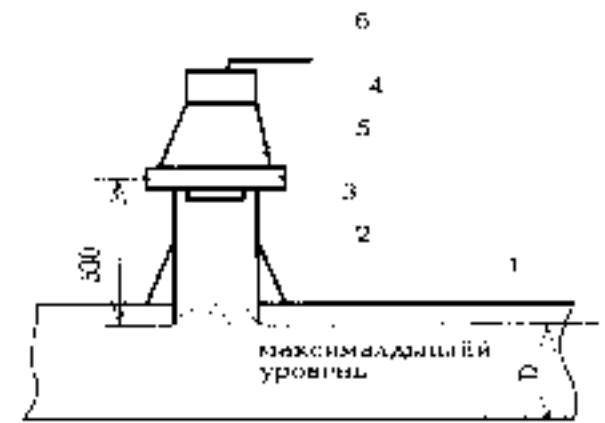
Схема монтажа расходомера на безнапорной трубе
